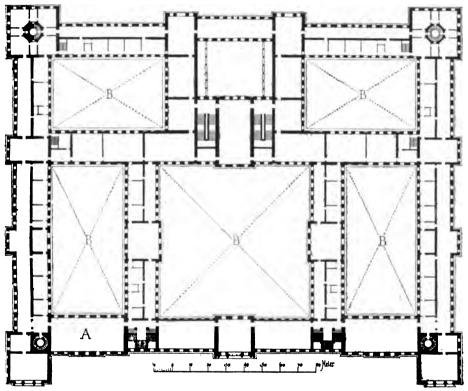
Jones' Plan zum Schloss Whitehall zu London.
